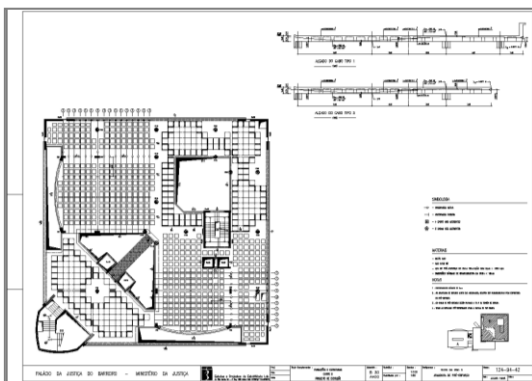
Pormenorização do pré-esforço nas lajes das Salas de Audiência
